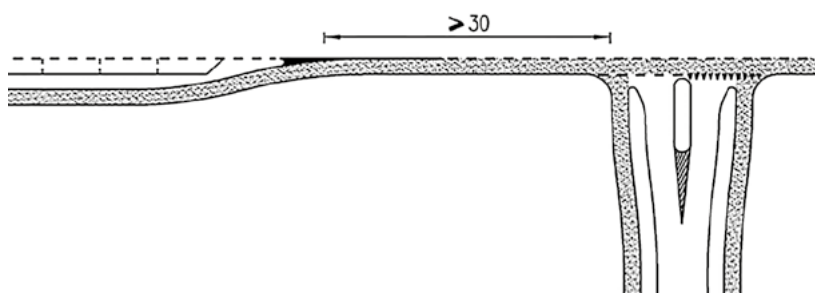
Przykładowe skrzyżowania z pierwszeństwem przejazdu
